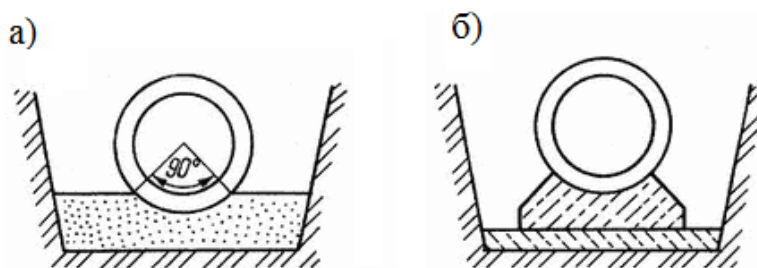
Основания под трубопроводы: а) песчаное; б) бетонное
